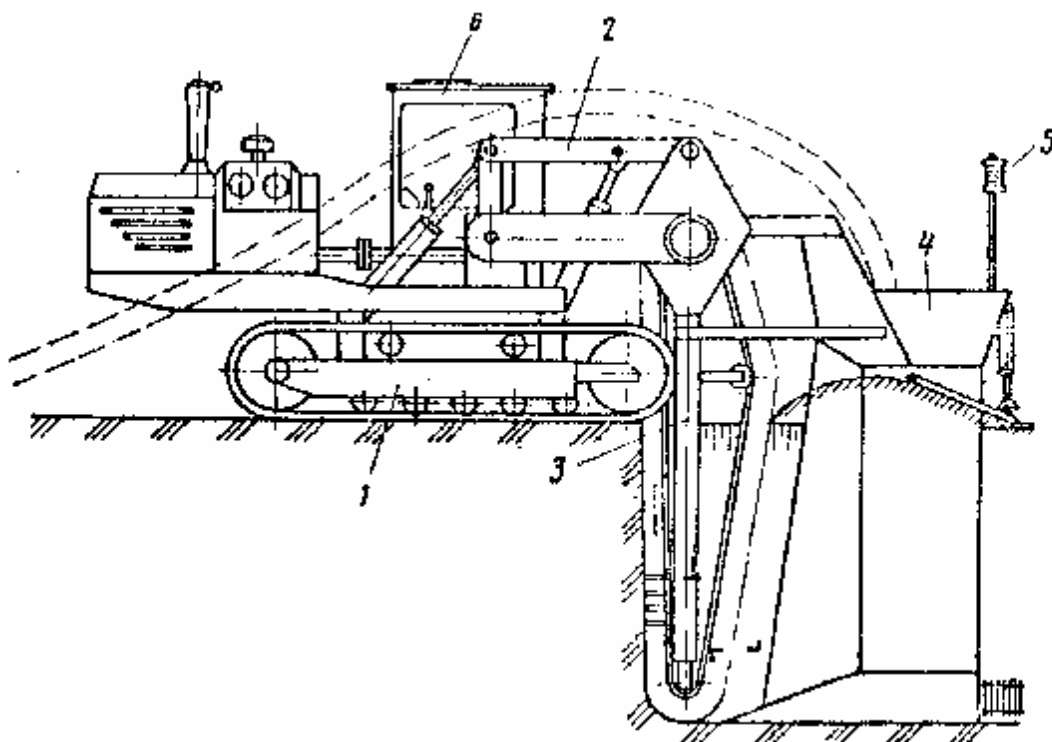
Конструктивная схема дреноукладчика для строительства горизонтального дренажа на орошаемых землях:
